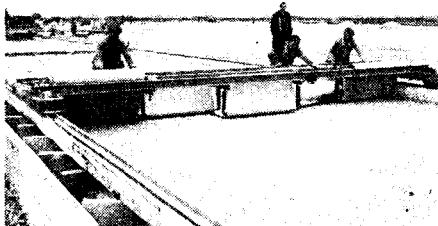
コンクリートの搾固め及び荒仕上に Dingler を用う
